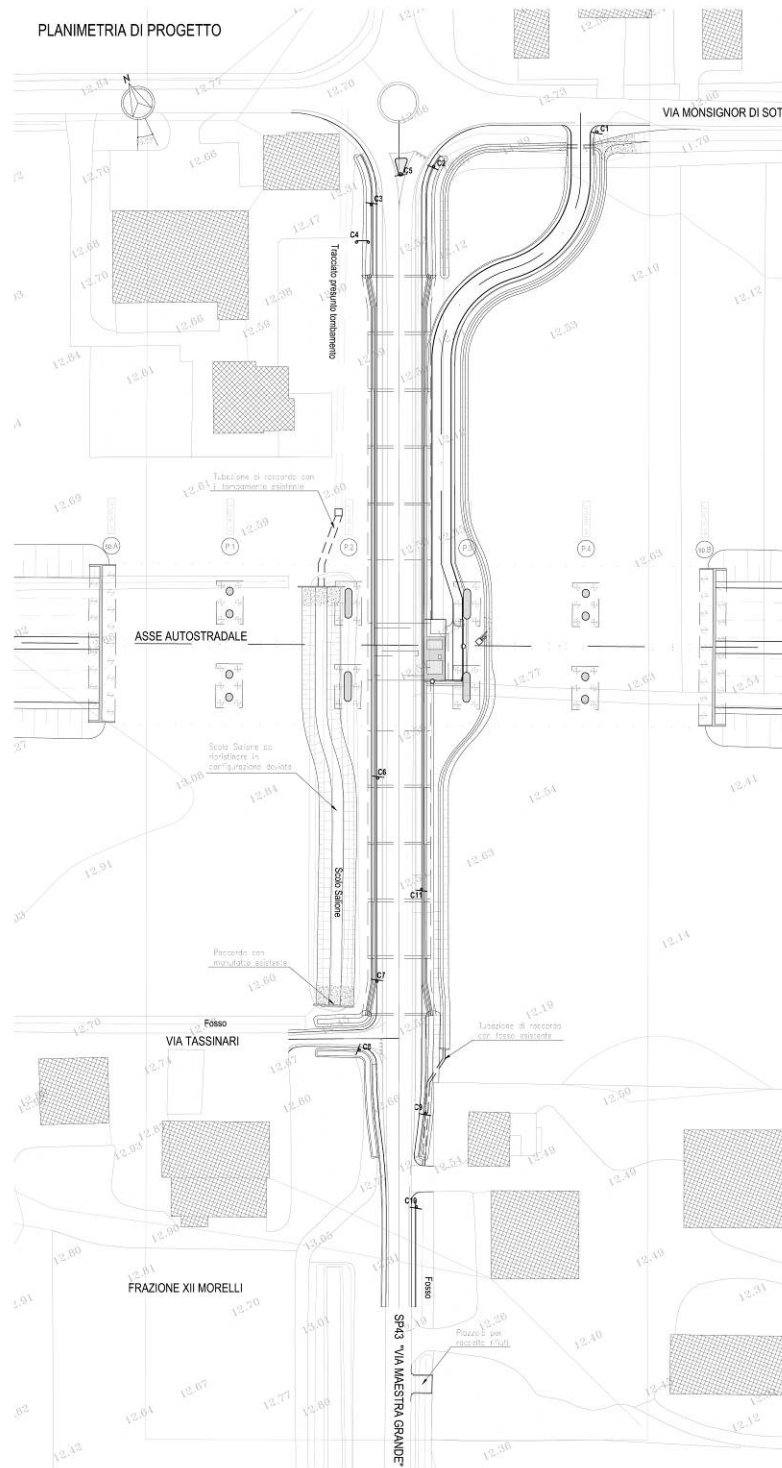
PLANIMETRIA GENERALE DELL'OPERA.
